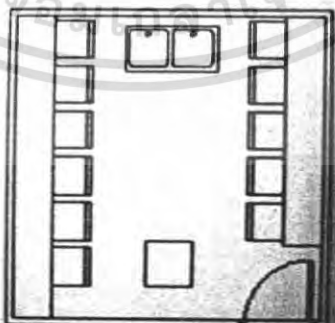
แสดงการวางผังประโยชน์ใช้สอยภายในห้องเรียนสื่อสาร (การพูด)
